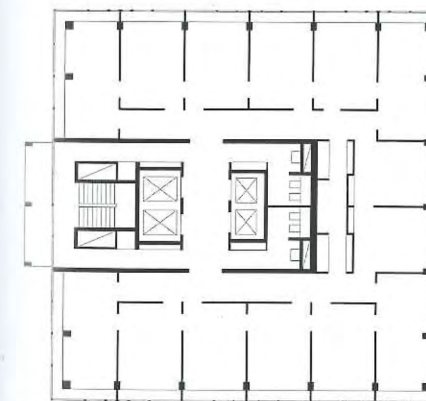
Grundriss Bestand (Quelle: Stefan Forster Architekten)
